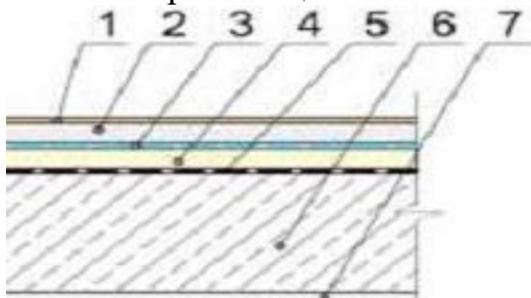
Улаштування теплоізоляції перекриття між першим поверхом і неопалювальним підпіллям з застосуванням пінополістирольних плит
